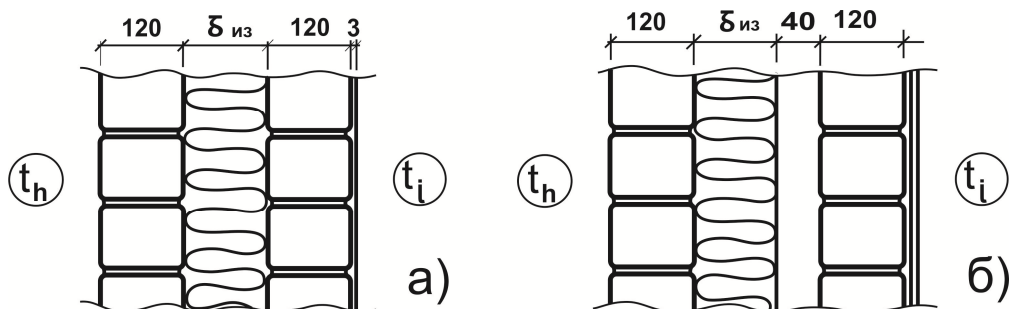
Схема целесообразных вариантов самонесущей кирпичной наружной стены с внутренним расположением листового теплоизоляционного слоя из минераловатных (стекловатных) плит без воздушной прослойки (а) и с воздушной прослойкой (б).
